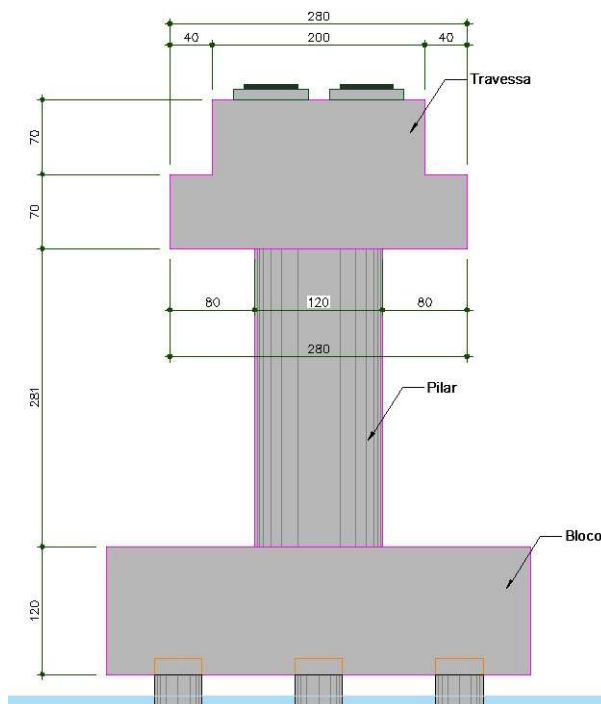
concepção da travessa e pilar central e seu pré-dimensionamento.
